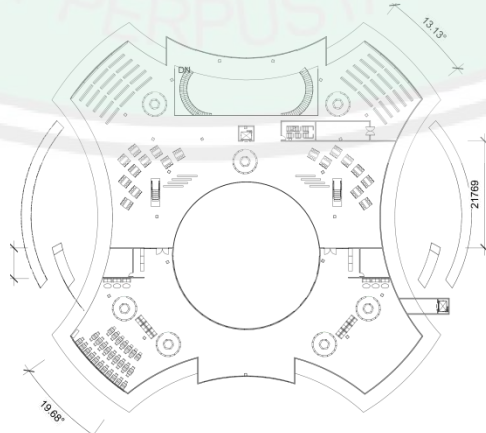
Denah Lantai 1 (Hasil Rancangan)
